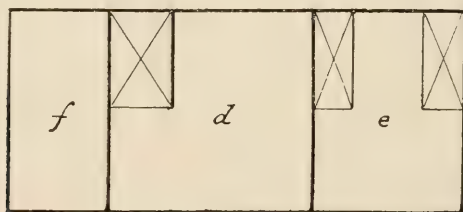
Plan d'un logement pour une famille d'ouvrier.
